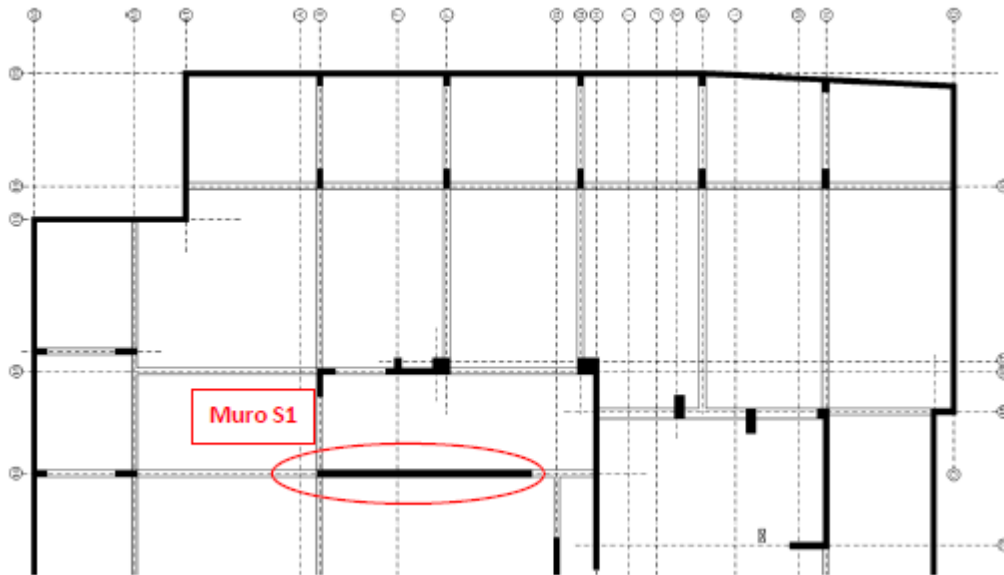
Ubicación muro dañado eje 14, primer subterráneo [18]
